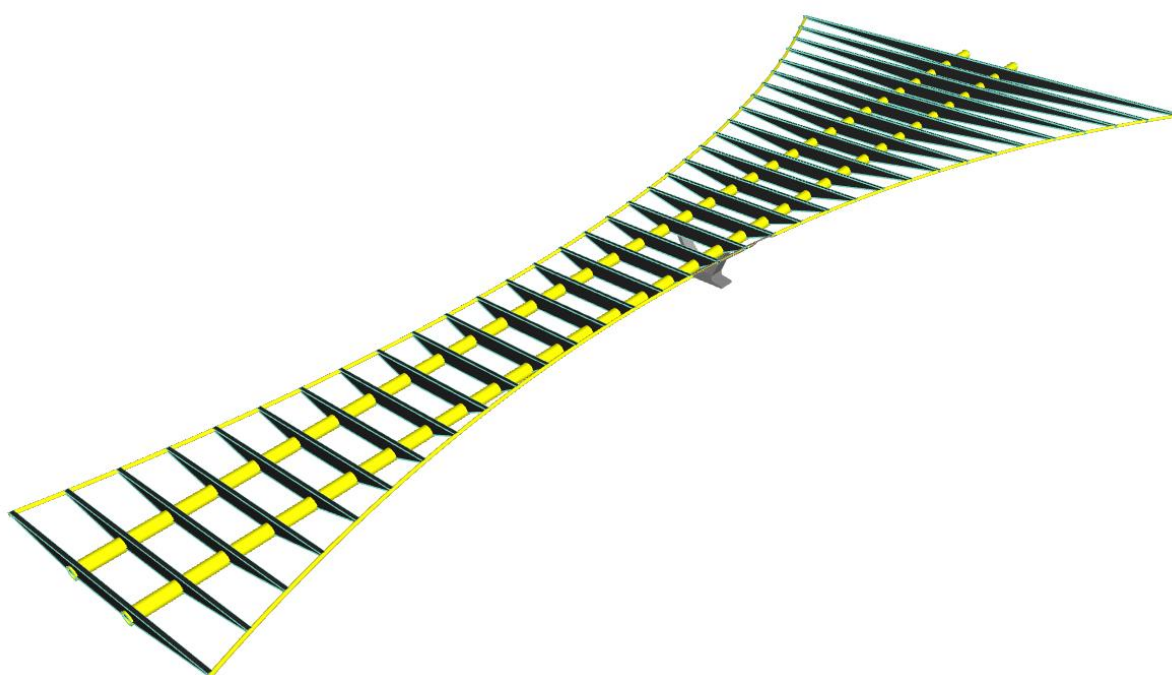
Perspectiva de colocação das vigas na estrutura da ponte
